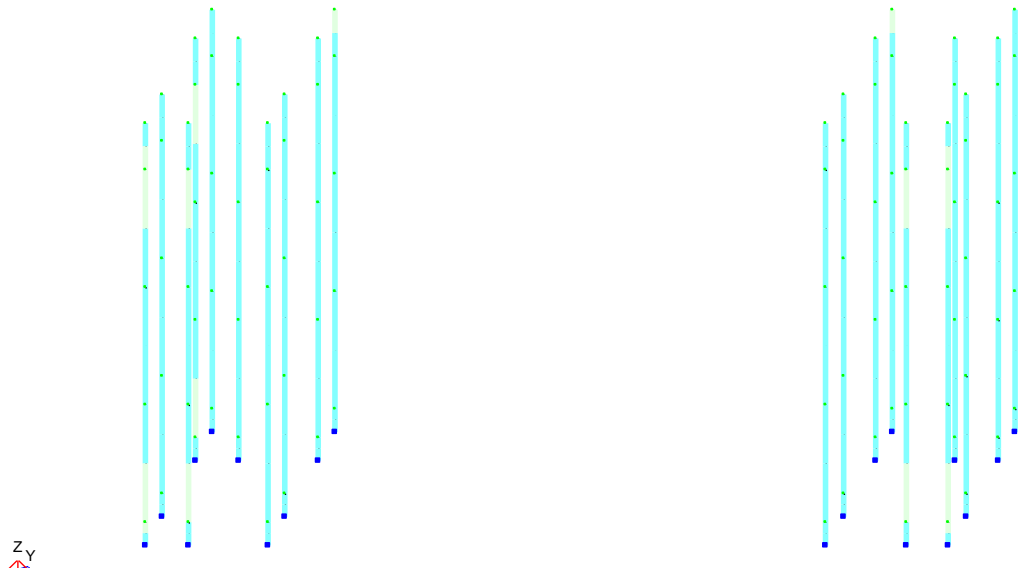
Площа подовжньої арматури у вугіллі перетину з урахуванням трещиностійкості AU1
